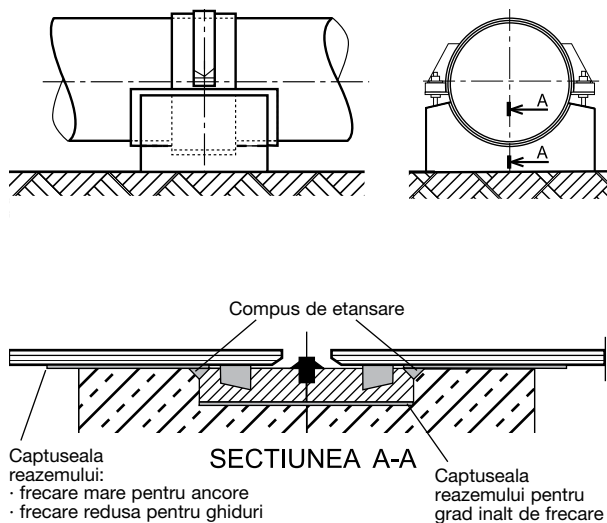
Ancorarea cuplajelor la suporturi de beton
